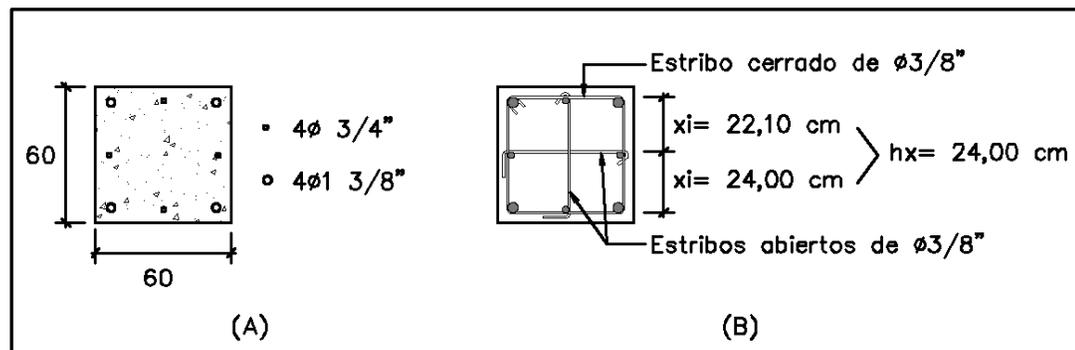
(A) Sección transversal de CM1, (B) Geometría de acero de refuerzo transversal de CM1 propuesto. Fuente: Autor.
